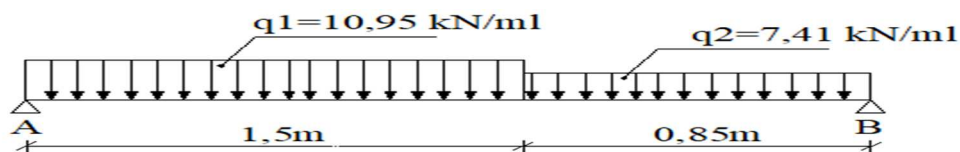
schéma statique de chargement d'un escalier droit à l'ELS
